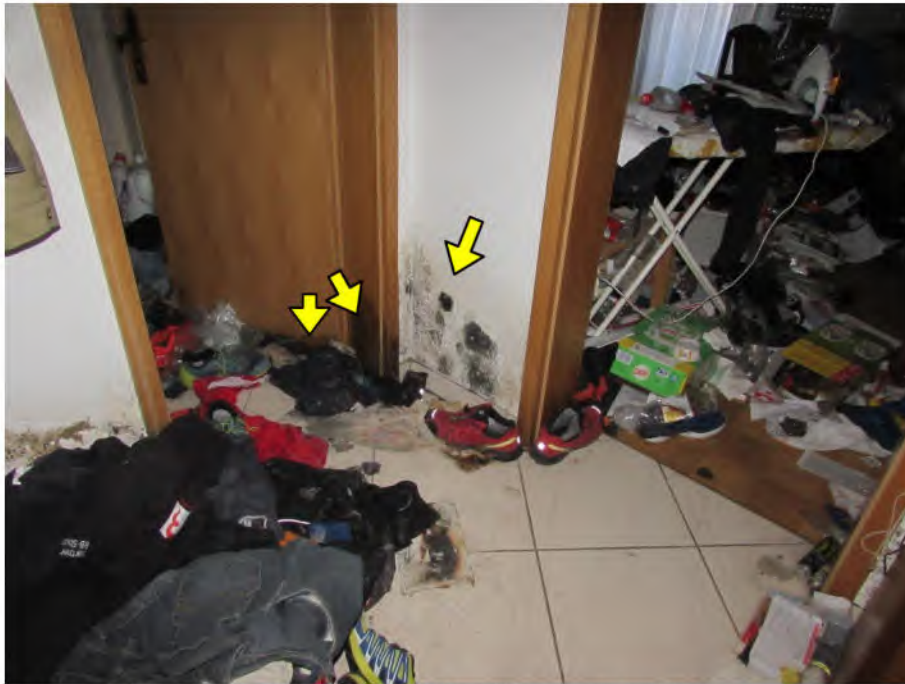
Diele: Schimmel im Wandbereich zum Bad hin, Feuchtigkeitsschäden an Tür und -zarge
